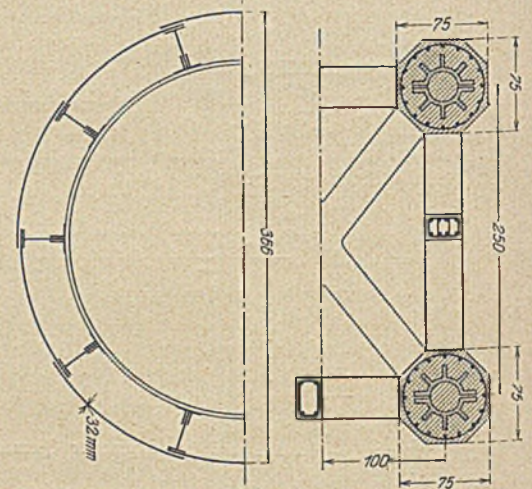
Firth of Forth-Brücke, ausgeführt in stahlumschnürtem Gußeisen.
